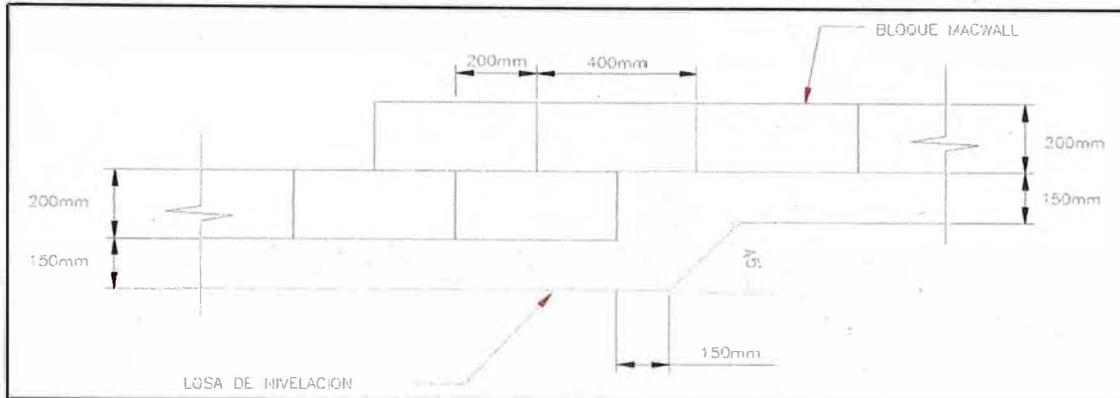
Muro de suelo reforzado – Detalle de Calzadura.
